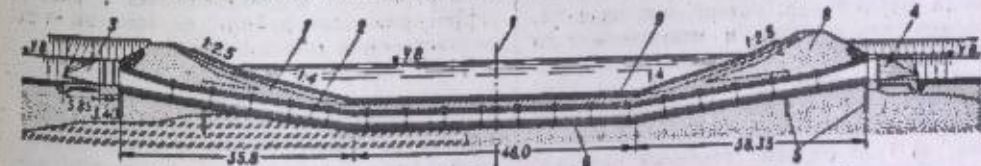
Железобетонный дюкер под судоходным каналом: 1 — ось судоходного канала; 2 — железобетонная труба дюкера; 3 — входной оголовок; 4 — выходной оголовок; 5 — шпунтовые ряды; 6 — бетонная подготовка; 7 — слой суглинки; 8 — приканальные дамбы (песчаные); 9 — защитная облицовка.
